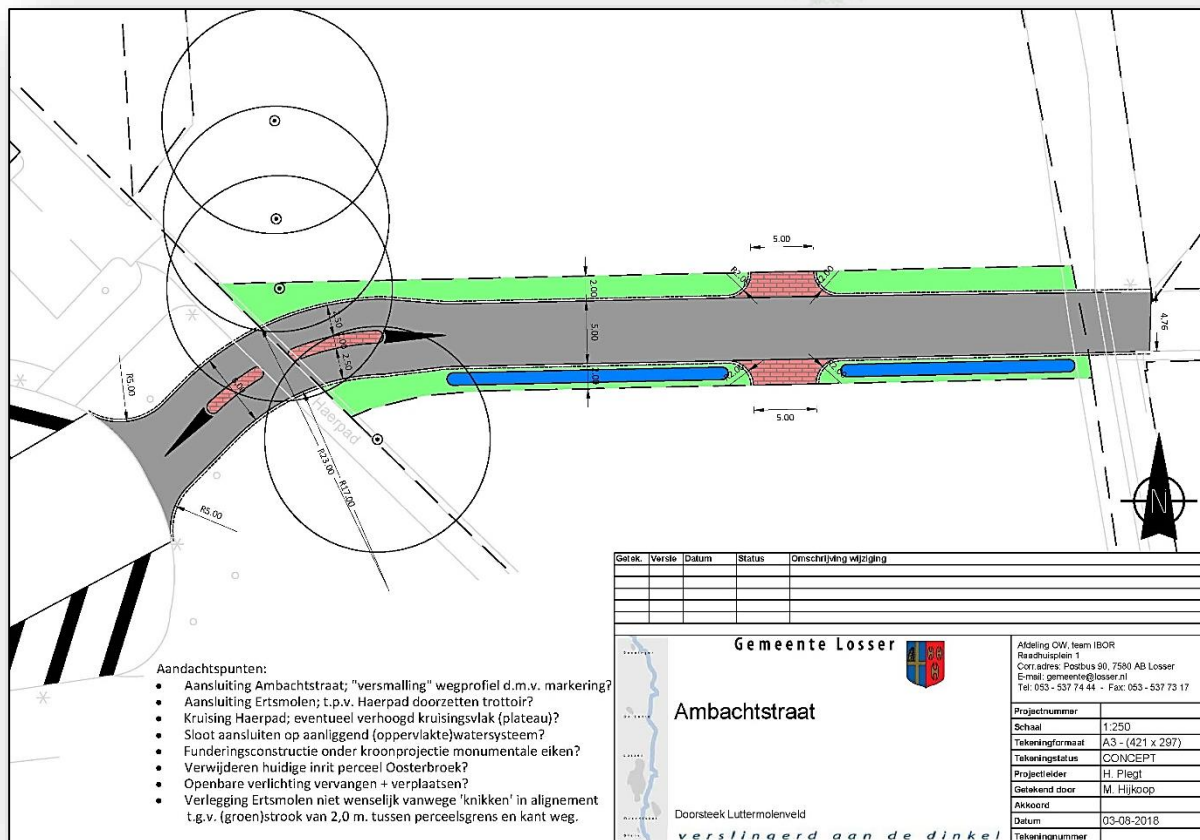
bovenaanzicht ontwerpplan Ambachtstraat De Lutte.
